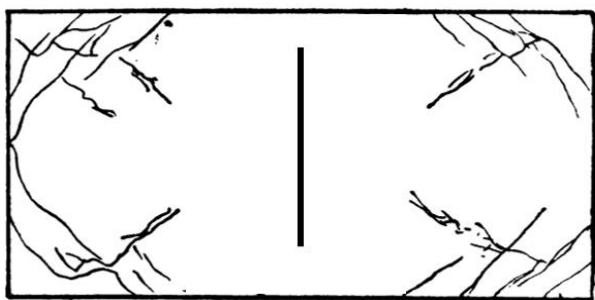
Схема излома плиты, испытываемой под нагрузкой
